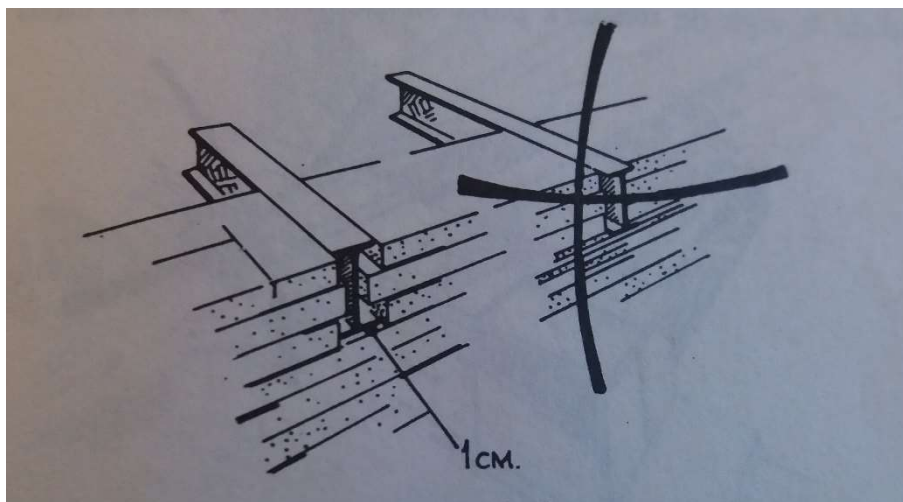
Representación del apoyo de vigas en paredes. [18]
